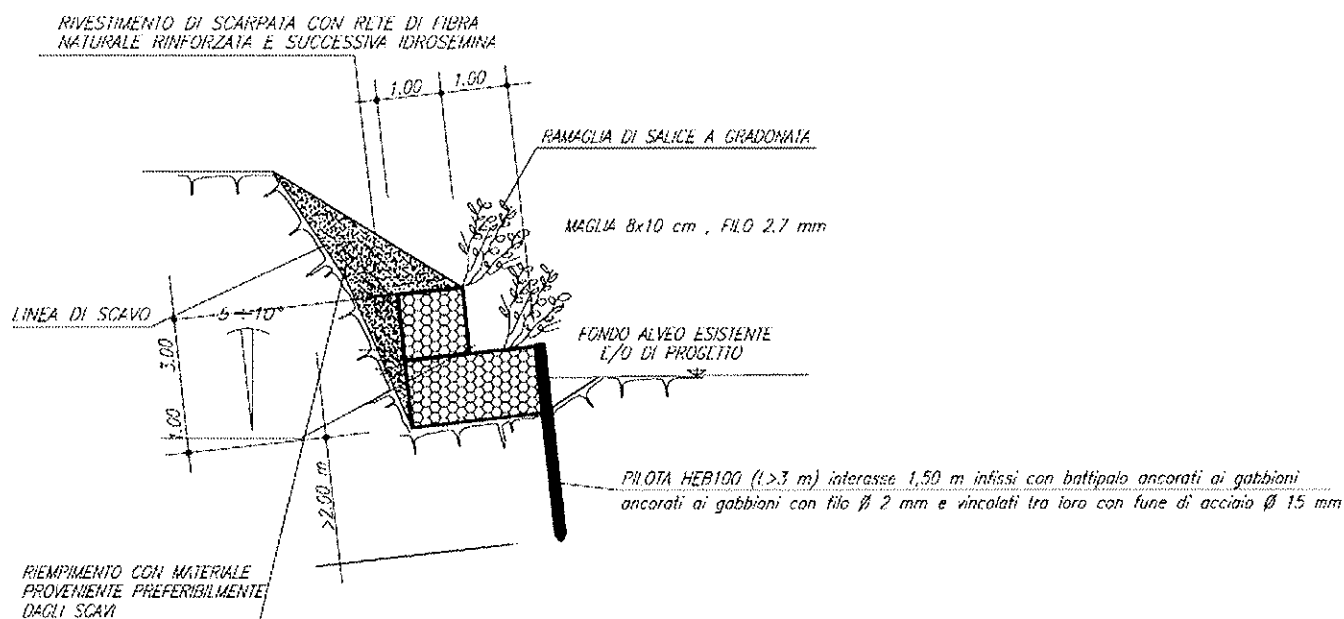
Schema della sezione tipo dell'intervento di ripristino delle erosioni spondali
